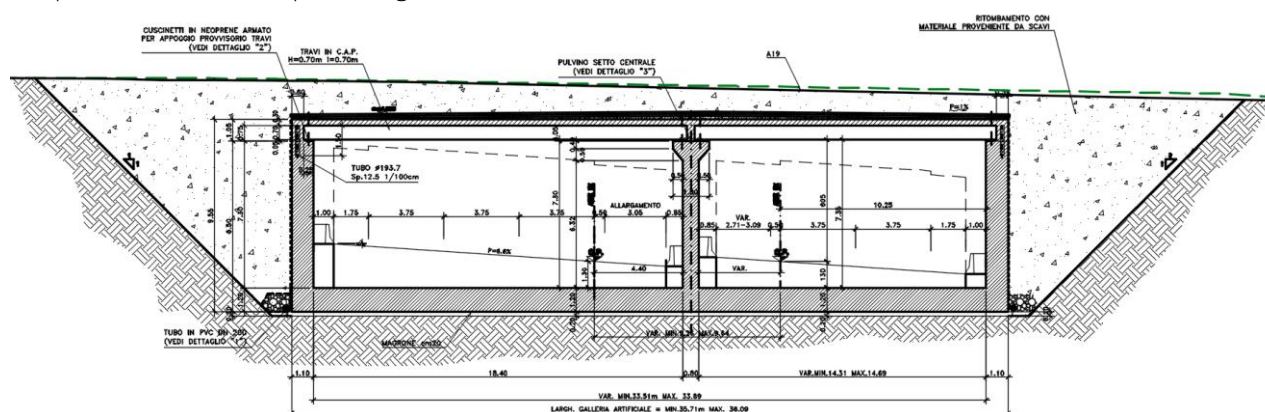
Sezione trasversale galleria artificiale doppia canna GA01
